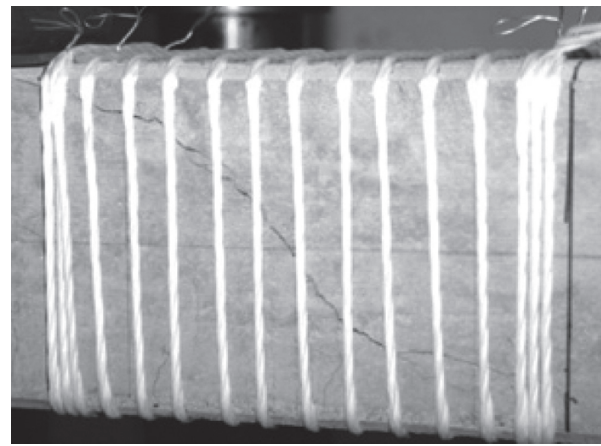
斜めひび割れ状況 (No.5)
